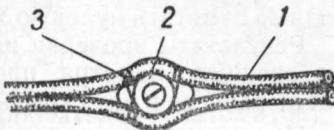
Прокладка провода АПН на роликах с разрезанием перепонки
